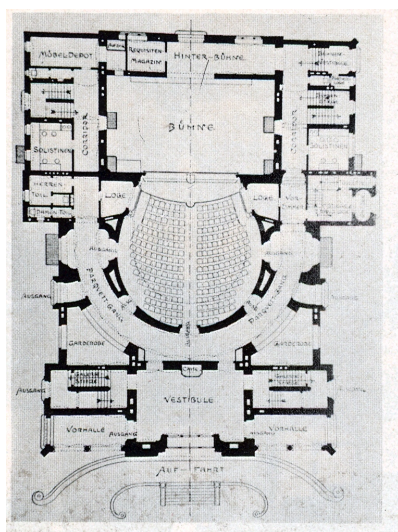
und 32: Grundriss Erdgeschoß und Obergeschoß
